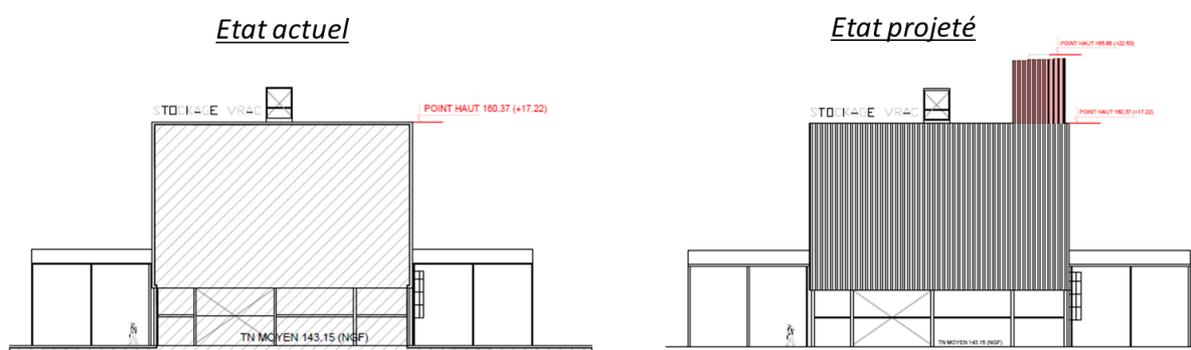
Plan de coupe avant et après l'installation de l'extension de la zone de chargement en vrac des prémix (source : Permis de construire)
